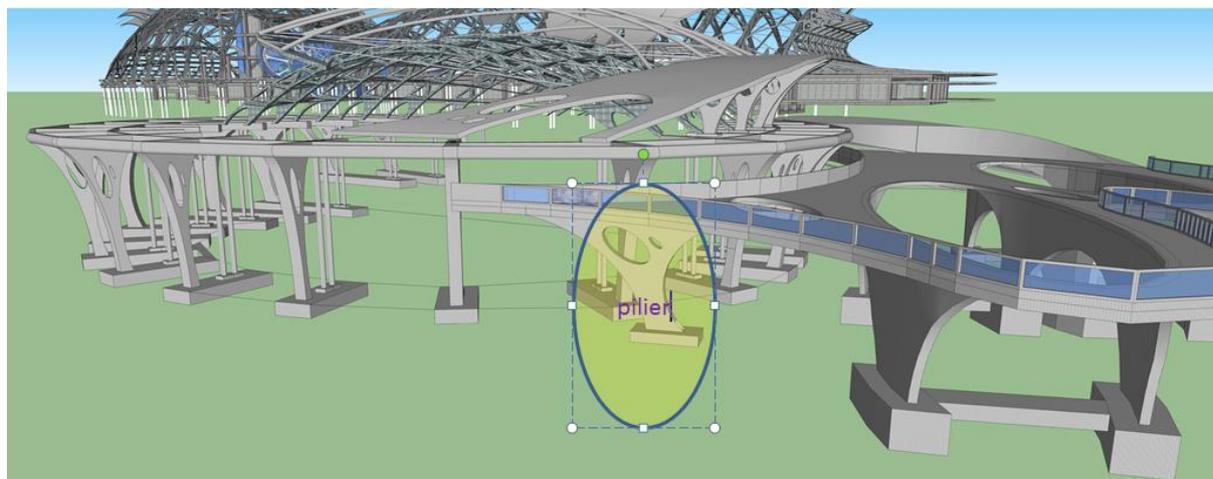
structure des gradins ; la poutre inclinée.
